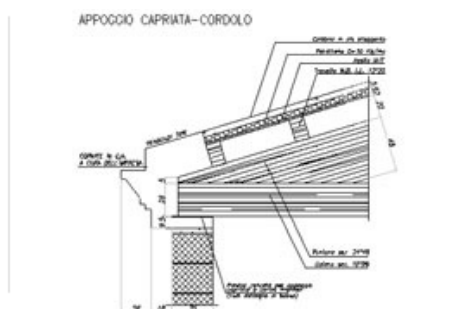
Particolare della realizzazione dell'appoggio delle capriate sulla muratura perimetrale.
